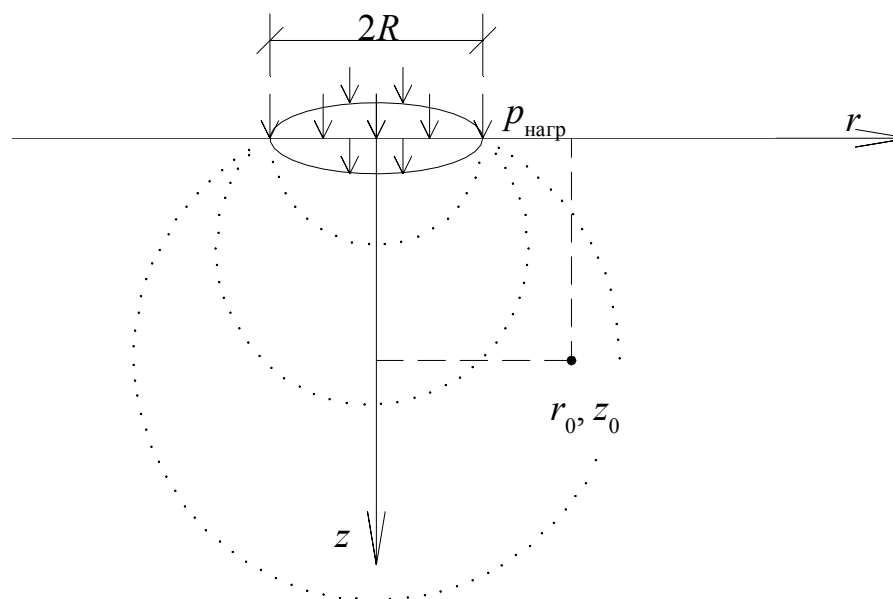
Уплотнение грунта под круглым в плане фундаментом
